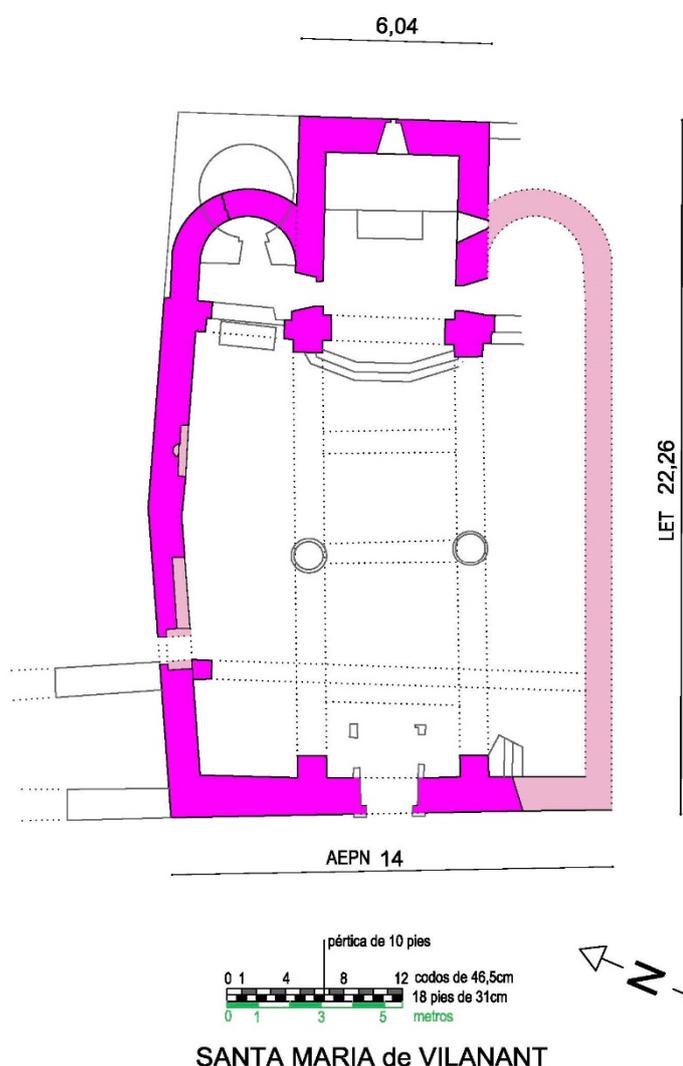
Planta crono-cromática de Sta. María. Elaborada por autora.
